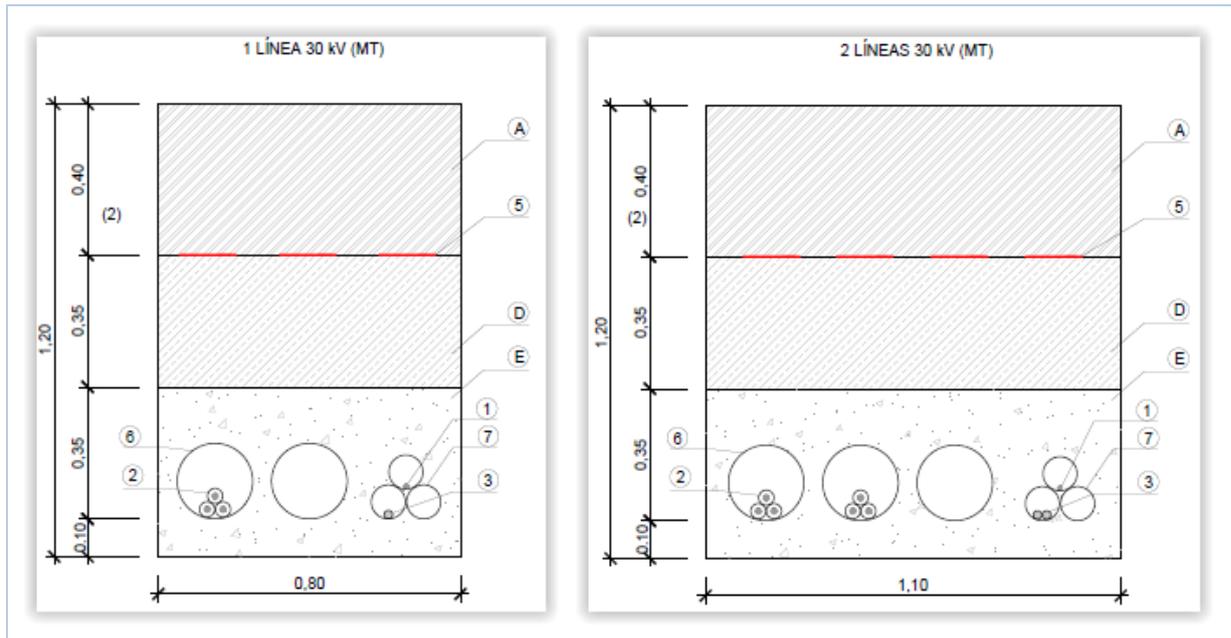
Detalle Sección Zanja. Tipo cruce vial o barrancos (1 de 2)
